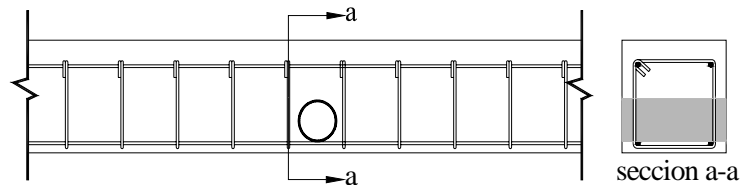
Recubrimiento inapropiado del refuerzo en una viga por la presencia de una tubería atravesada transversalmente.
